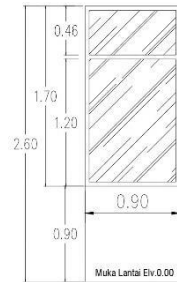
Denah Rencana Kusen lantai 1
